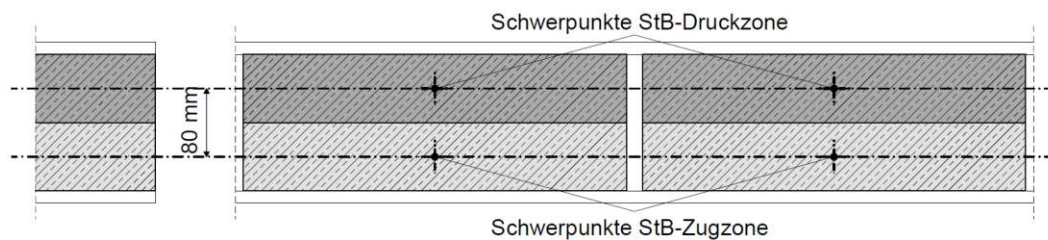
Hebelarm der *Tragwirkung Stahlbeton
